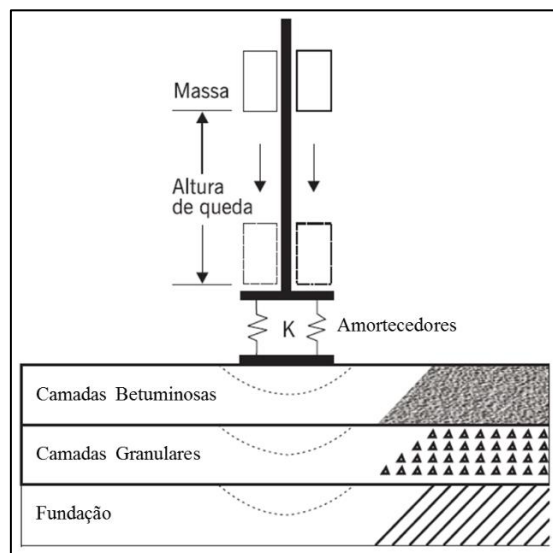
Aplicação da carga no pavimento (adaptado de Bernucci, L. B. et al, 2010)
